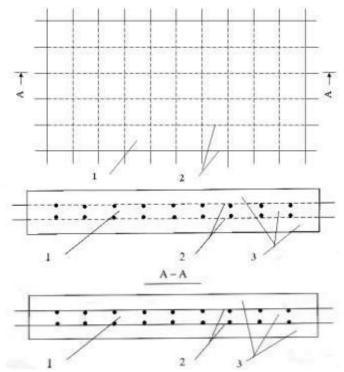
Плита сборного покрытия из асфальтобетона, армирована не менее чем двумя слоями полимерной арматуры: 1 — ячейка арматурной решетки; 2 — арматурная решетка из полимерных материалов; 3 — заполнитель из асфальтобетонной смеси.
